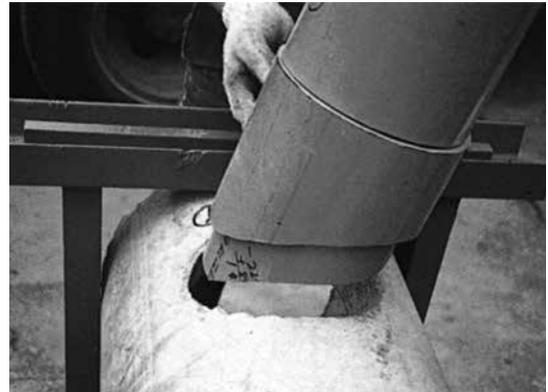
既設管と塩化ビニル管の接合状態 取付部組立状況
